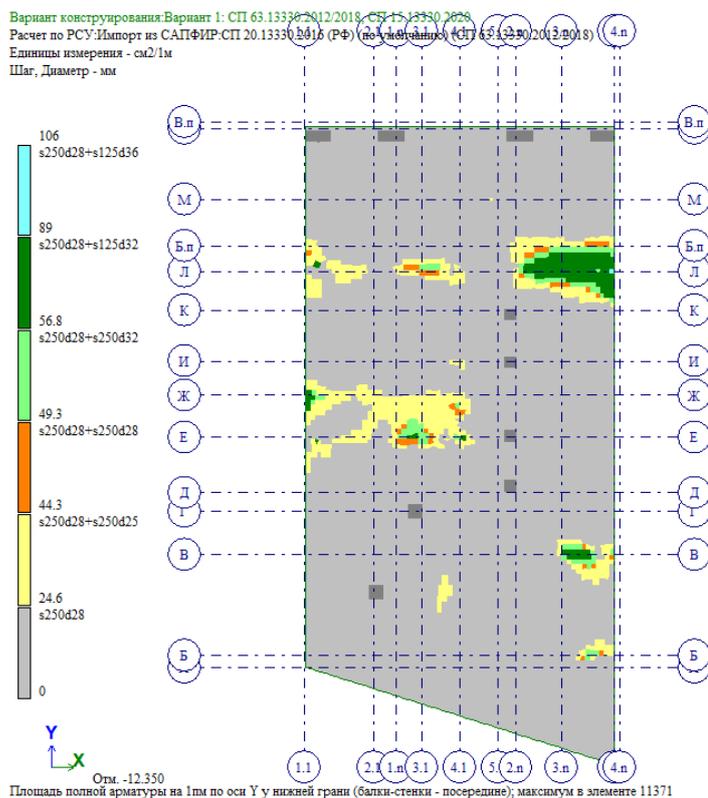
Армирование плиты по оси Y у нижней грани (на 1 м.п.)
